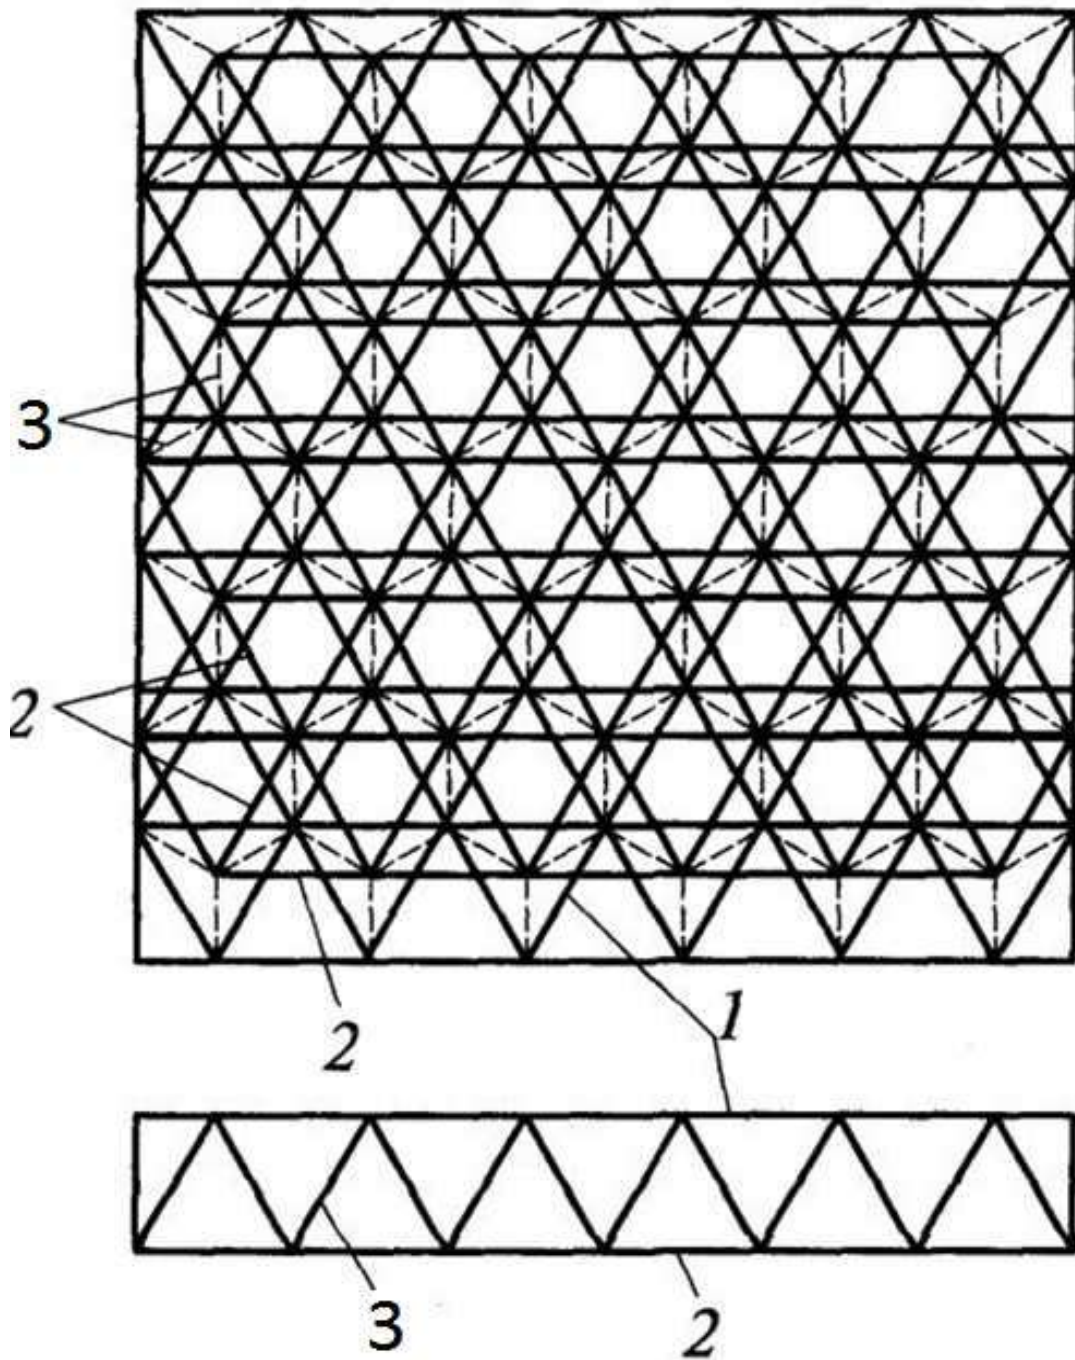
Структурное покрытие с ячейками треугольного плана:
